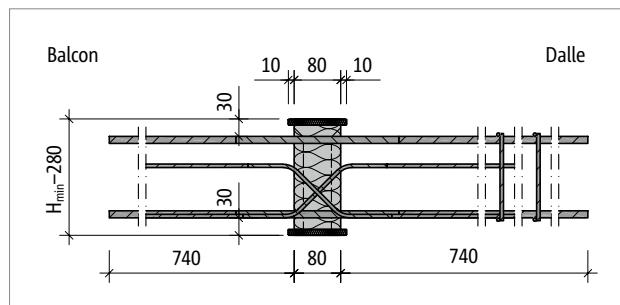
Schöck Isokorb® T types D-MM1-VV1 à MM5-VV1 à CV30 : coupe du produit
